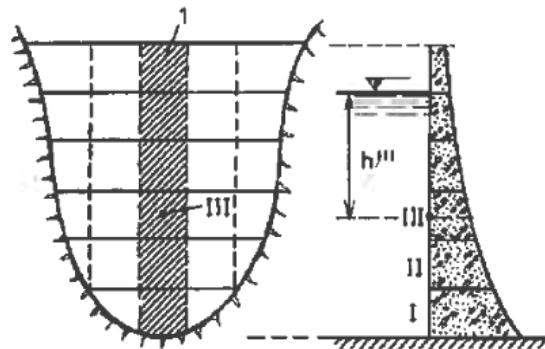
Secção transversal e perfil longitudinal utilizados para o method of central cantilever
